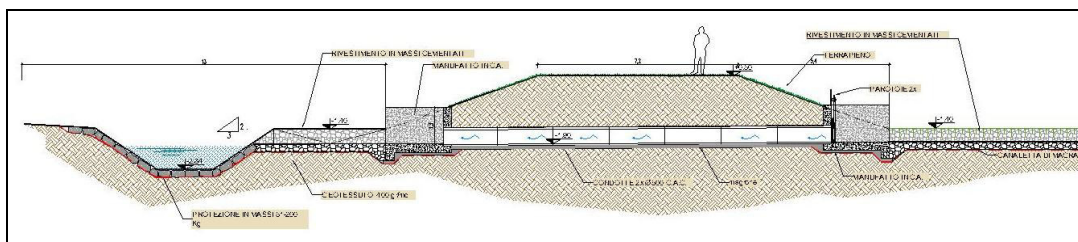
sezione opera di restituzione su collettore Acque Basse
